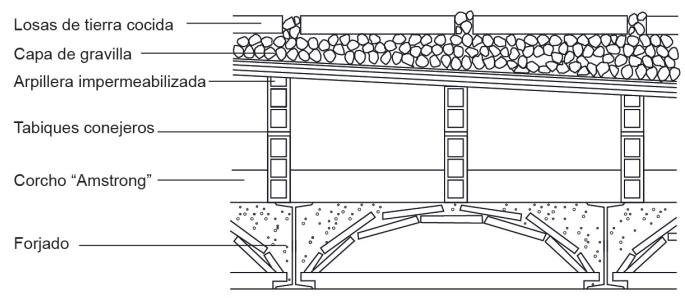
Planos de sección del edificio de la calle Muntaner. Fuente: Paricio Casademunt (1996, p. 421).
